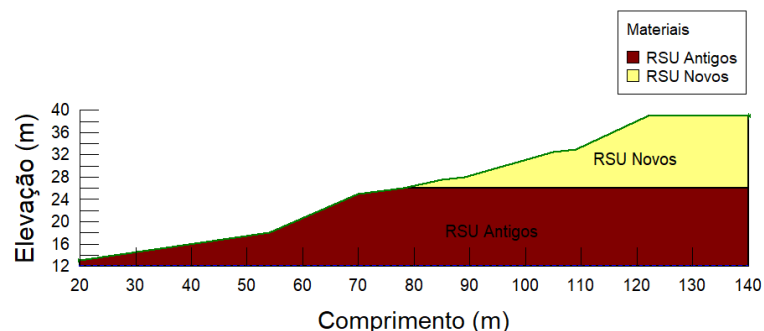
Geometria do aterro sanitário da zona norte de Porto Alegre.
